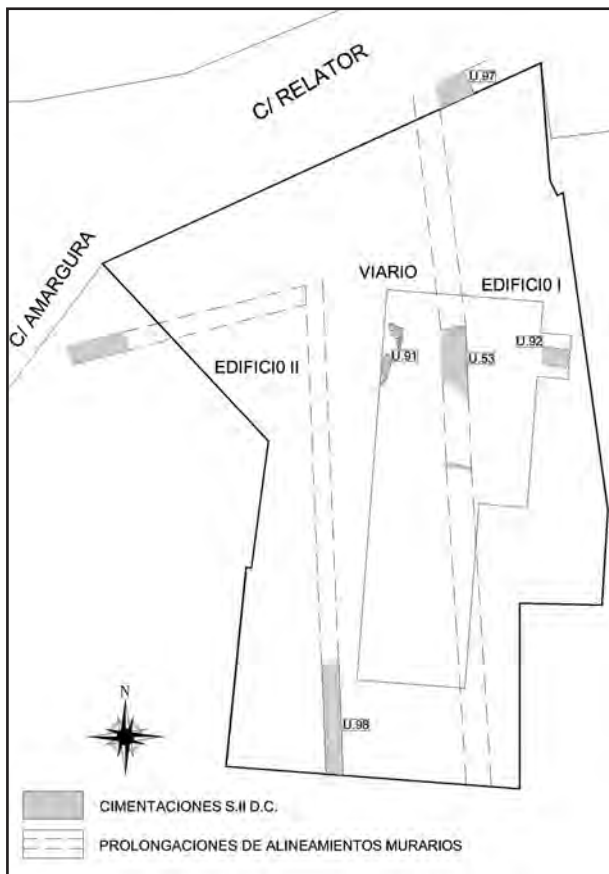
Planta de las cimentaciones romanas halladas en calle Relator 44 y 44 B.
